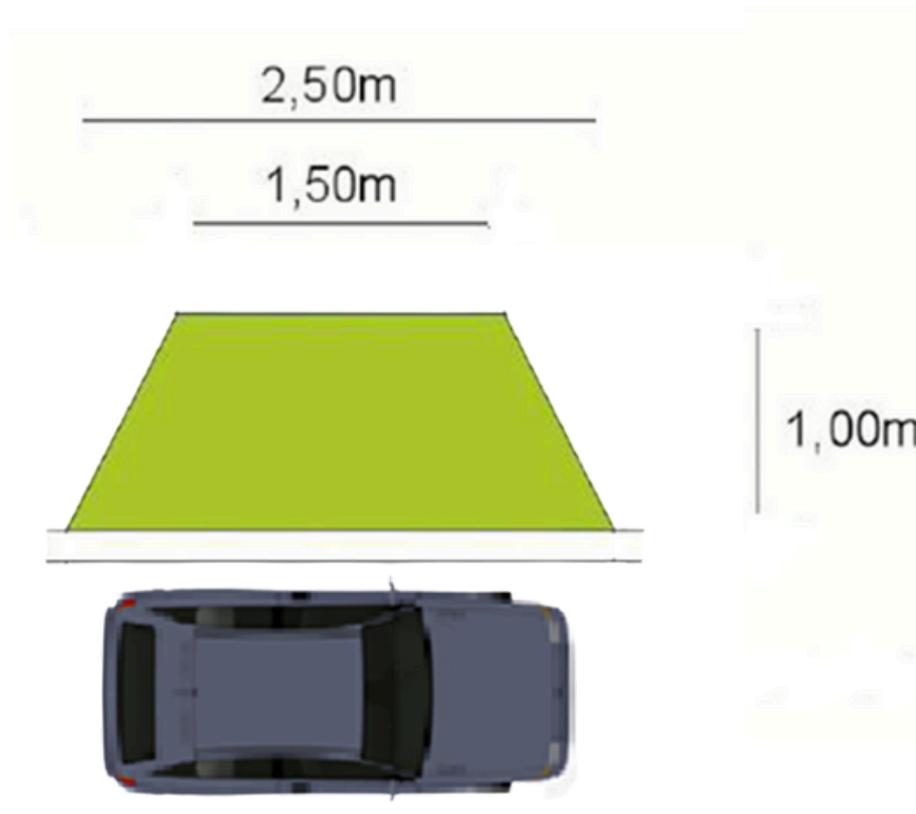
Detalhe das dimensões do canteiro trapezoidal.
